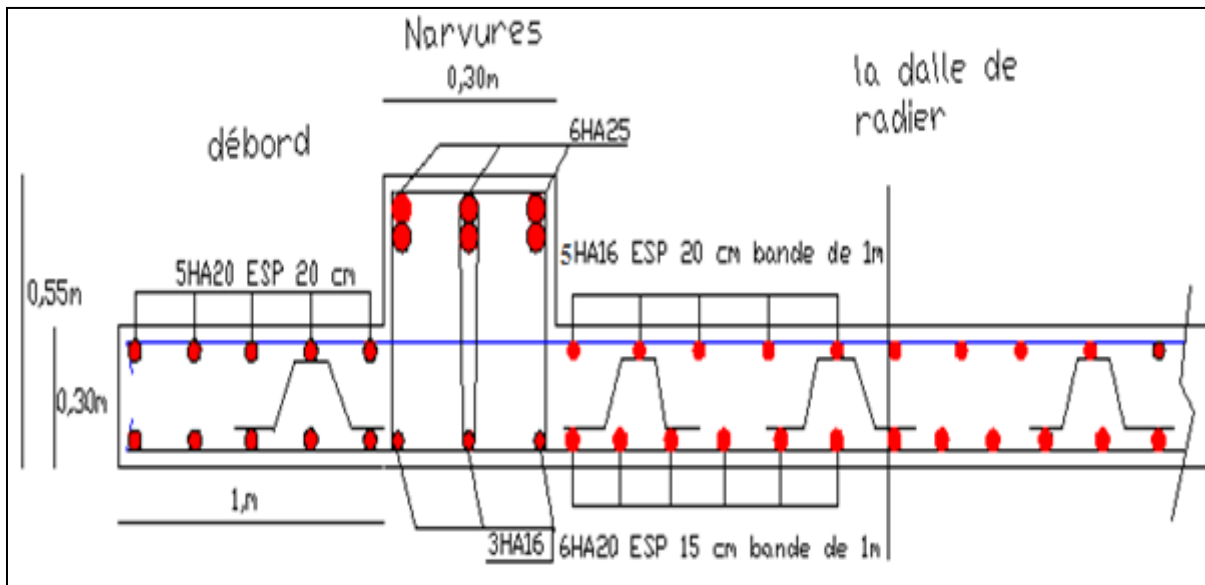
Ferrailage du radier générale sens Y-Y coupe en travée
